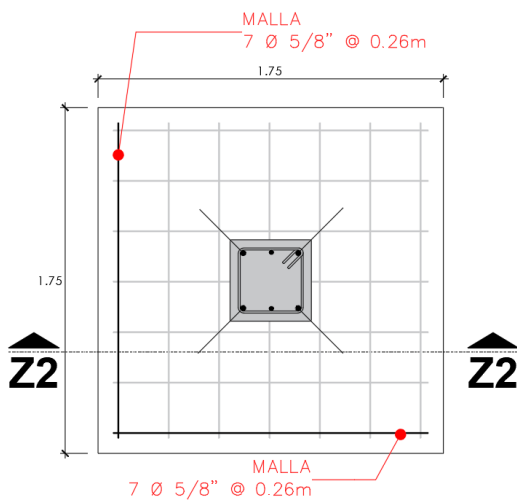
Detalle en planta de zapata (suelo estabilizado).
